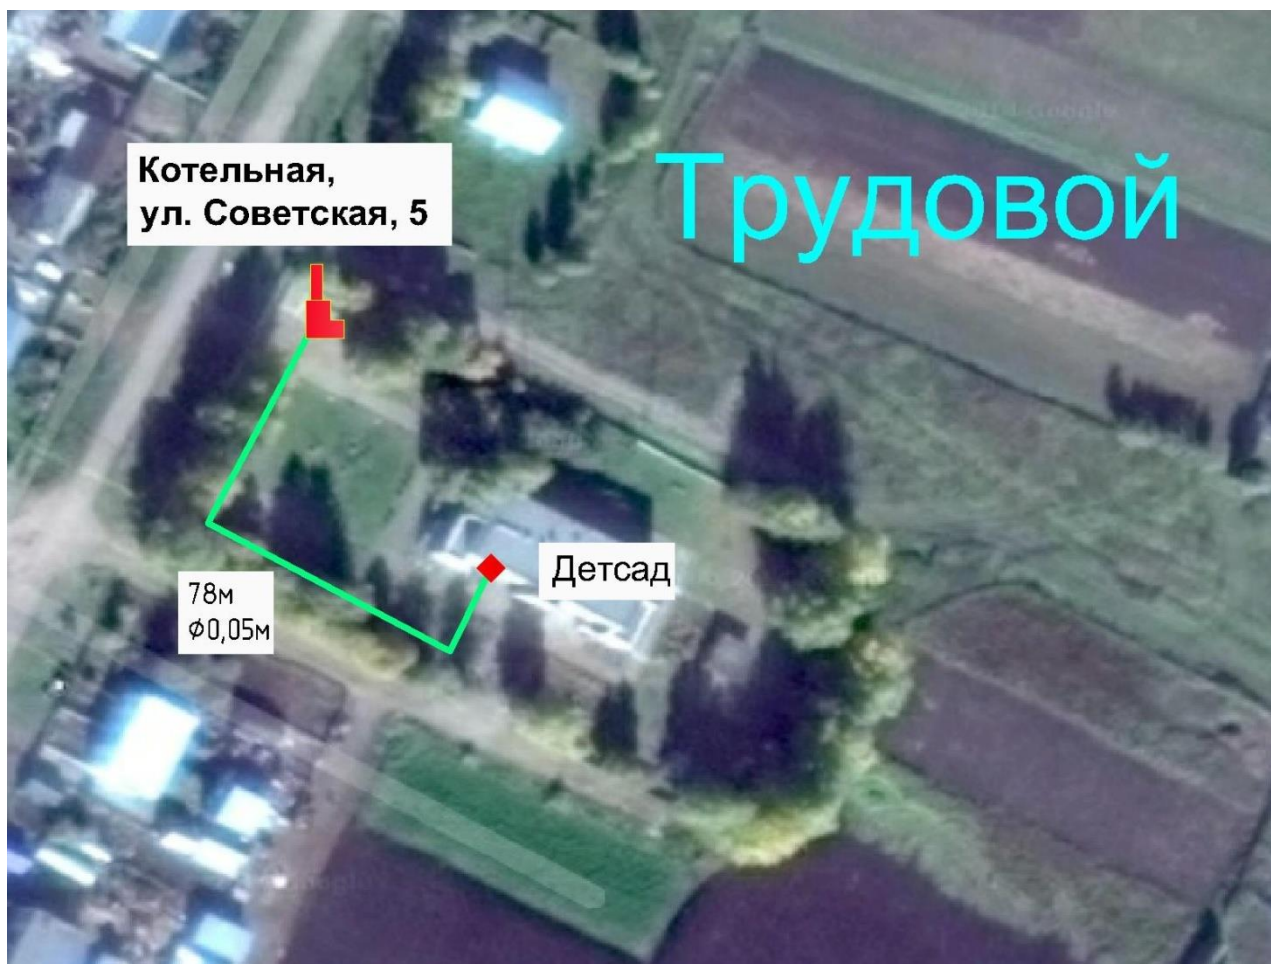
Схема тепловых сетей от котельной детского сада
